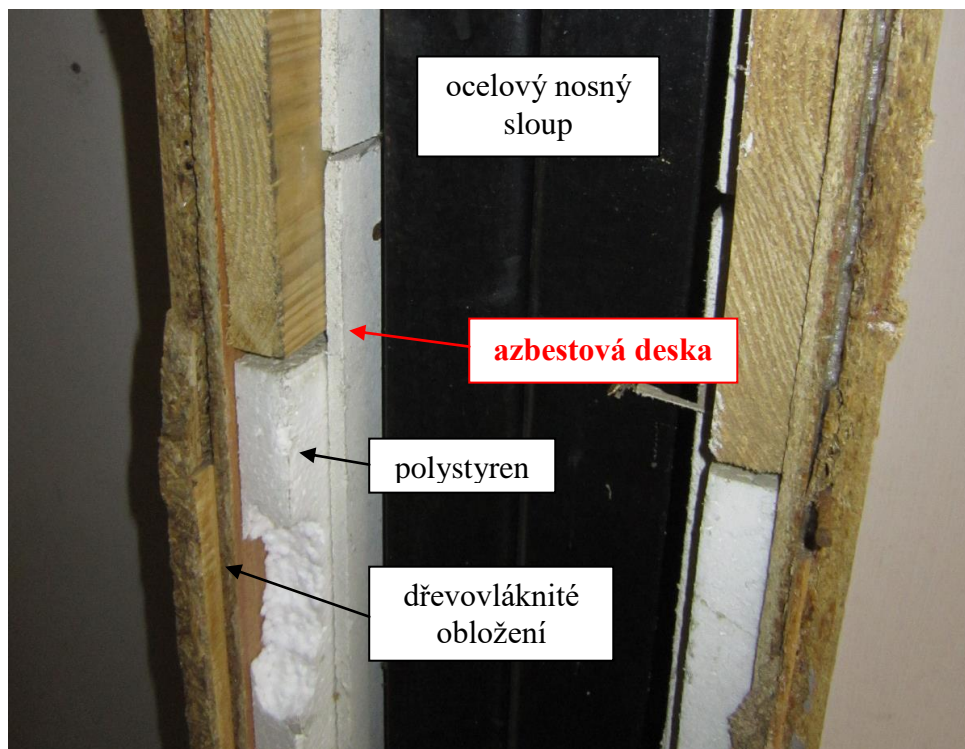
Pohled na obložení nosných ocelových sloupů 1.NP. Detail.
